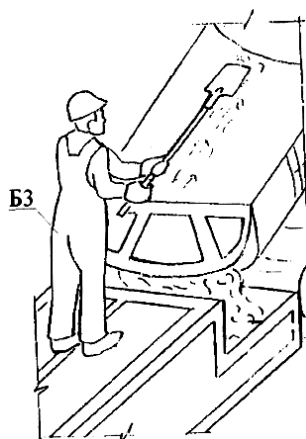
Выгрузка бетонной смеси из кузова автосамосвала
